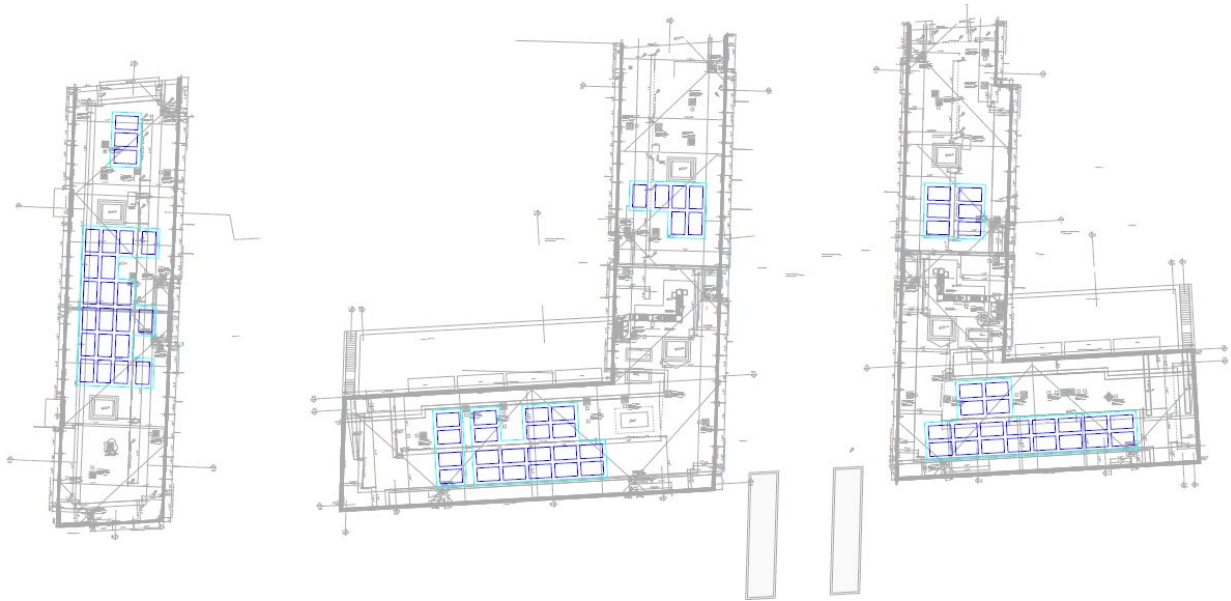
Geplante Lage der Versuchsflächen für das Dachexperiment
